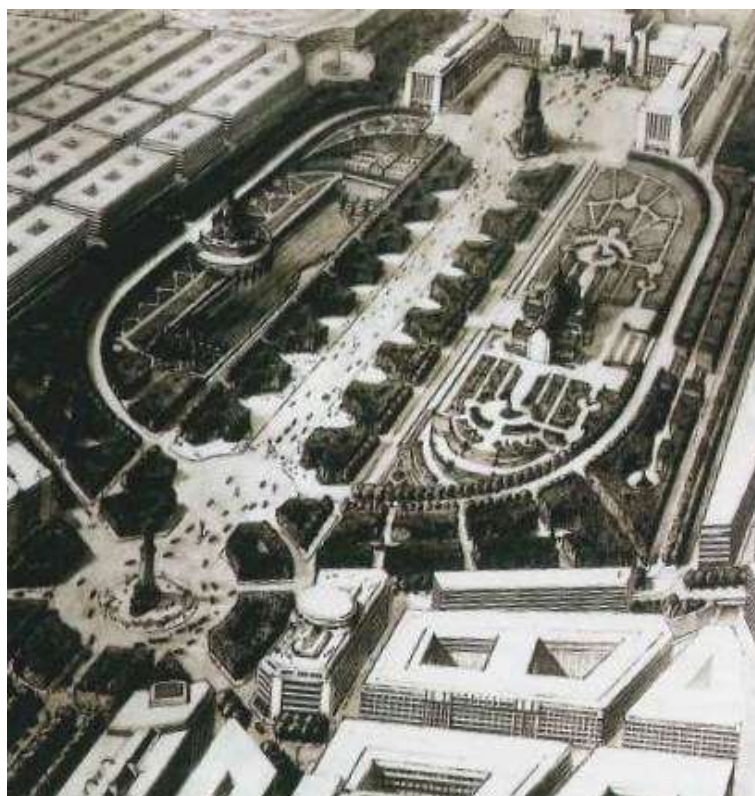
Planta da proposta de Luís Cristino da Silva (Luís Cristino da Silva, 2005, p. 34)
